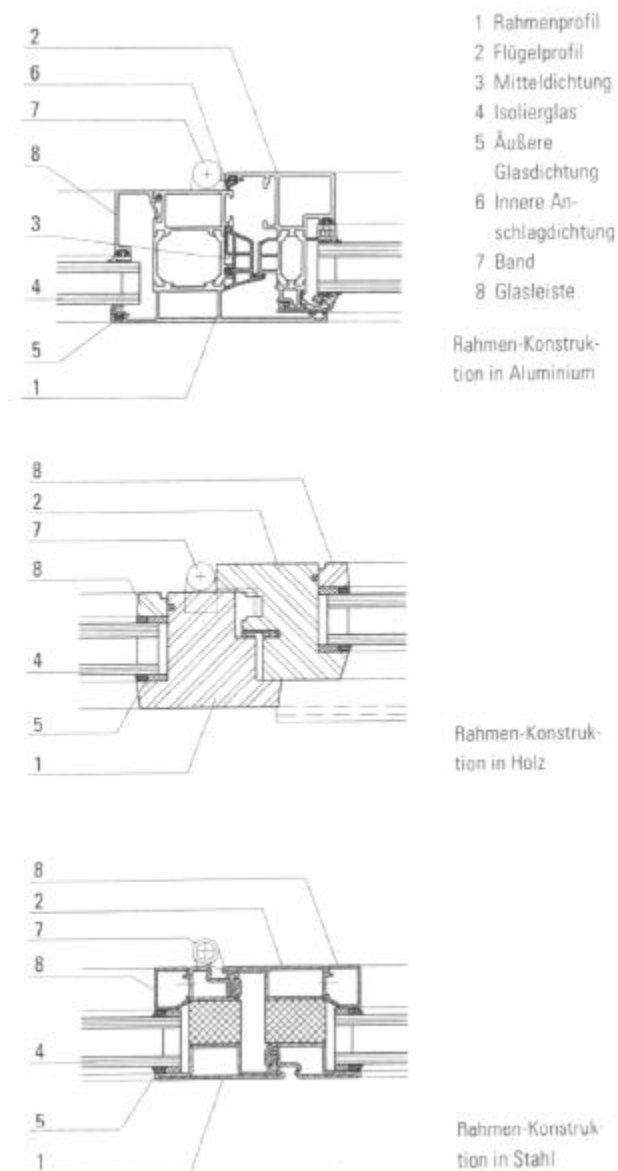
Verschiedene Rahmenkonstruktionen, schematischer Profilschnitt, Quelle: Doppelschalige Fassaden S. 133
